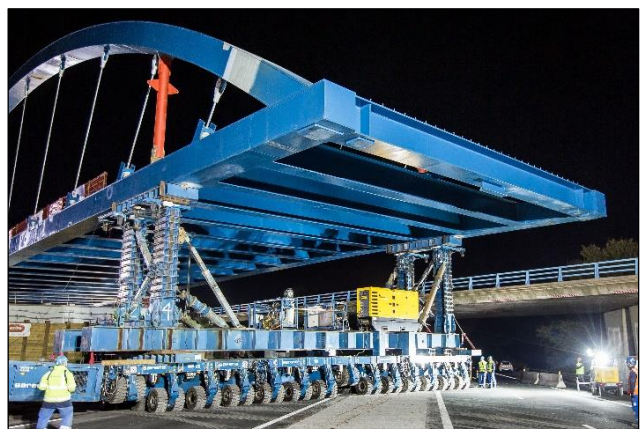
Renforcement d'un tablier bow-string par des butons provisoires (en rouge sur la photo)
